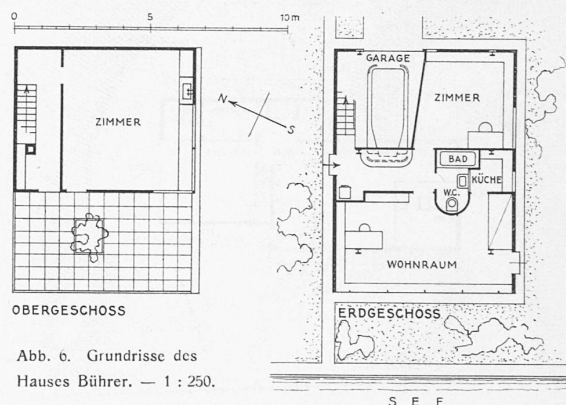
Grundrisse des Hauses Bühler. — 1 : 250.
